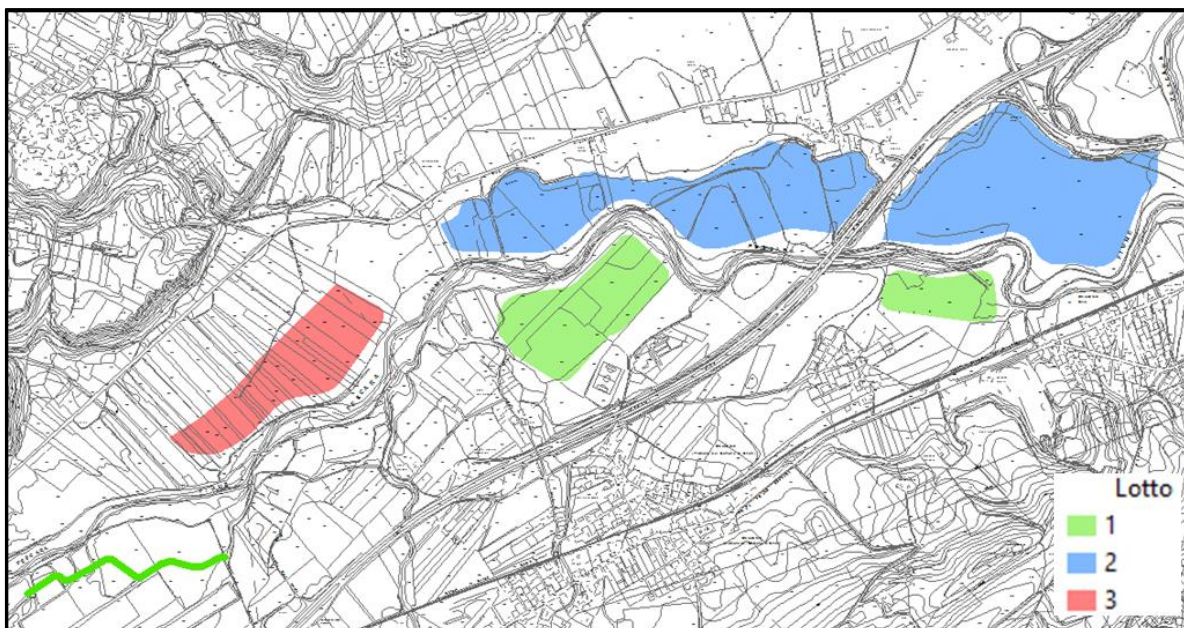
Planimetria dell'intervento con evidenziata la suddivisione in lotti funzionali.
